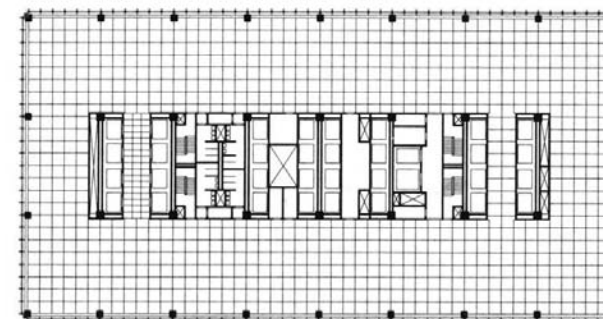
Banco Toronto (planta do pav. tipo), 1963
